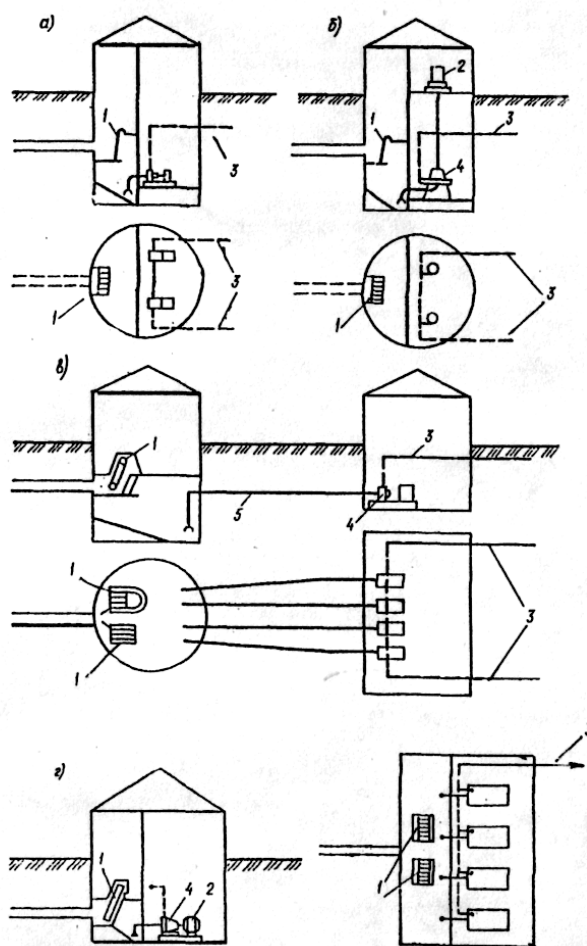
Схемы насосных станций: а, б – шахтного типа соответственно с горизонтальными и вертикальными насосами; в – с отдельно стоящим приемным резервуаром; г – прямоугольная в плане; 1 – решетка; 2 – электродвигатель; 3 – напорный трубопровод; 4 – насос; 5 – всасывающий трубопровод
